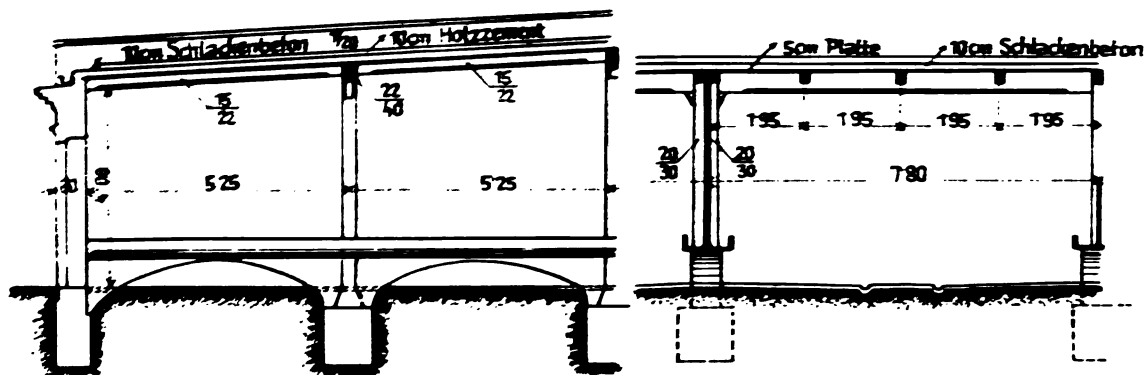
Quer- und Längenschnitt durch ein Stallgebäude.
